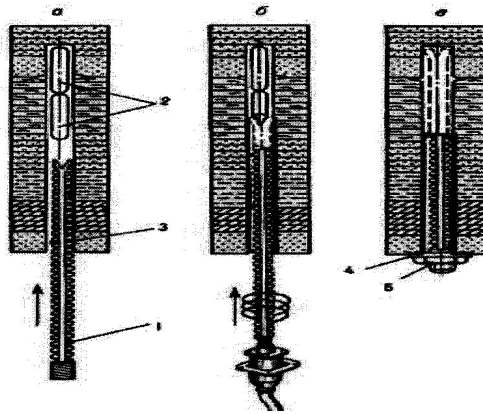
Схема закріплення анкеру хімічними речовинами: а – введення анкеру в шпур; б – перемішування речовин в шпурі; в- закріпленій анкер з опорною плитою; 1- анкер; 2- ампули з хімічним закріплювачем; 3 – ущільнююче кільце; 4 – опорна плита; 5 – натяжна гайка.
